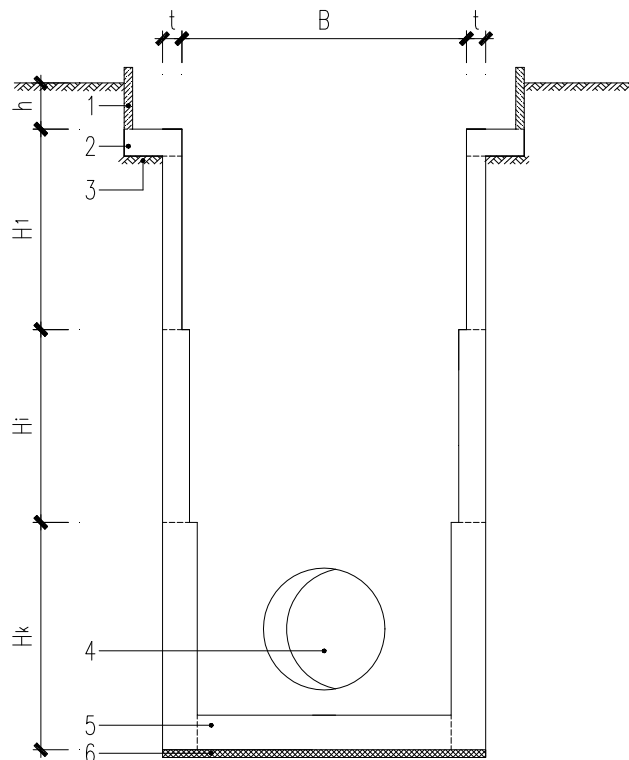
逆作钢筋混凝土壁板结构组成剖面
